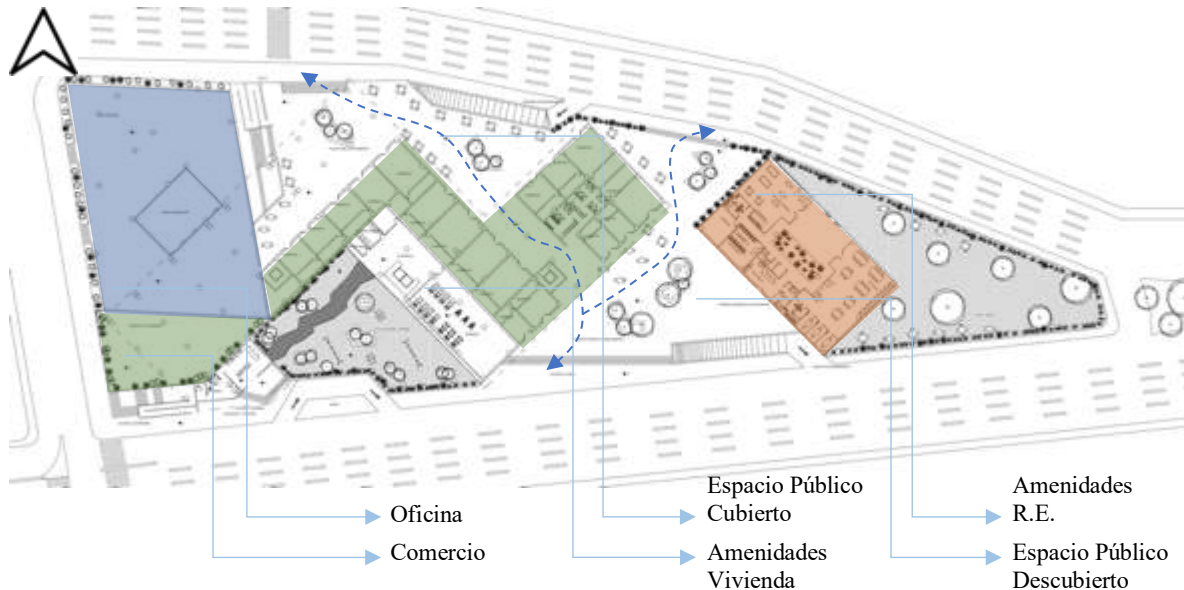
Propuesta de zonificación de conjunto en planta baja, etapa d. Fuente: Elaboración propia.
